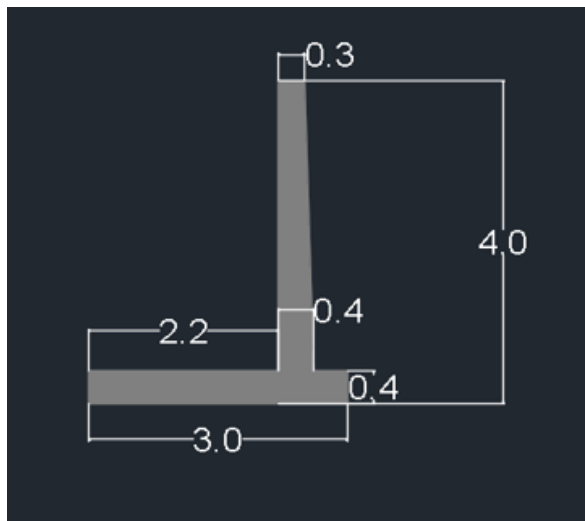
Dimensionamiento Muro de contención K0+970– K0+980
